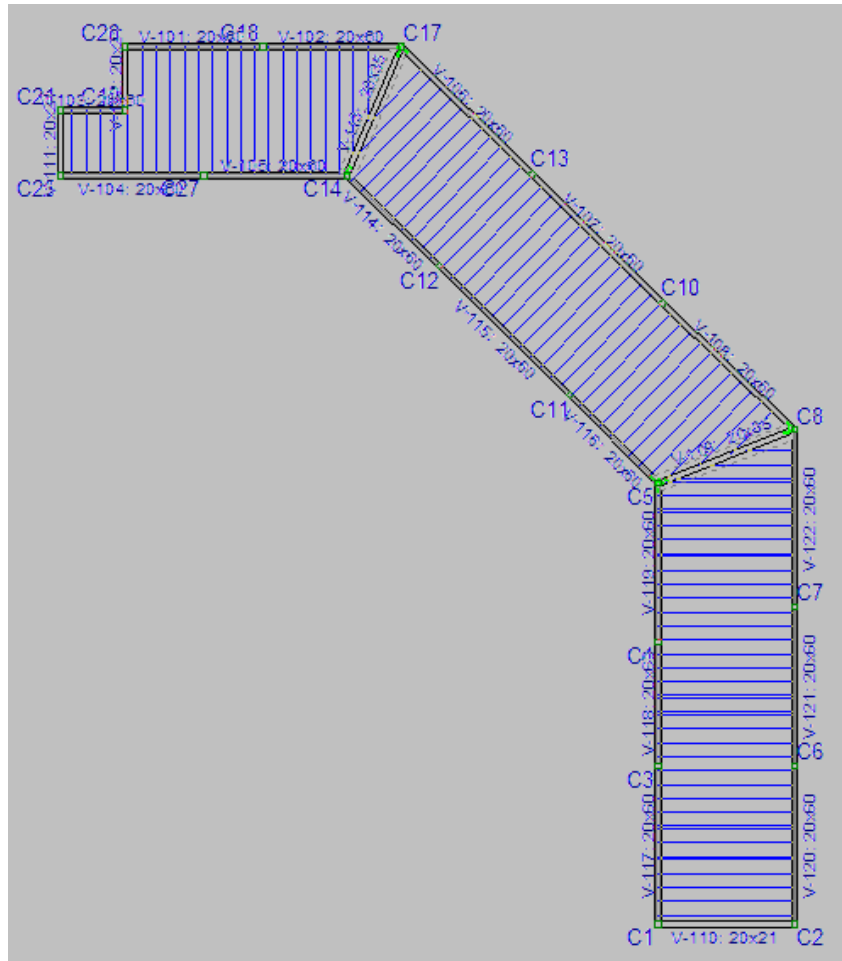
Propuesta estructural losa galería (fuente: elaboración propia).
